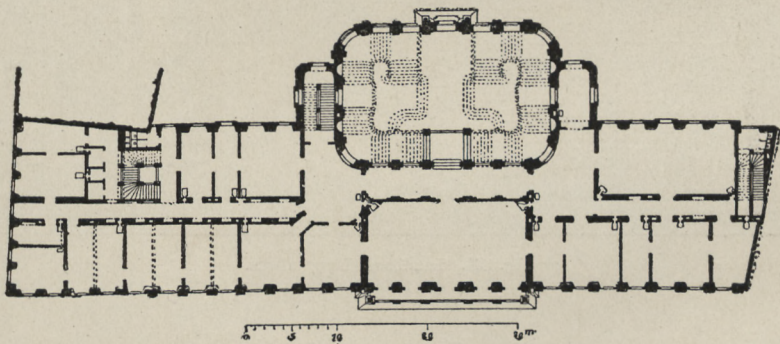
Landhaus, Grundriss des Hauptgeschosses.
